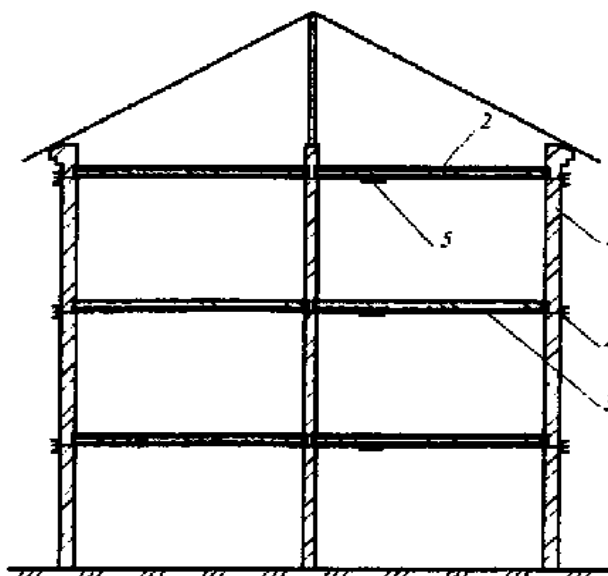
Усиление стен стальными тяжами, устанавливаемыми под перекрытия:
